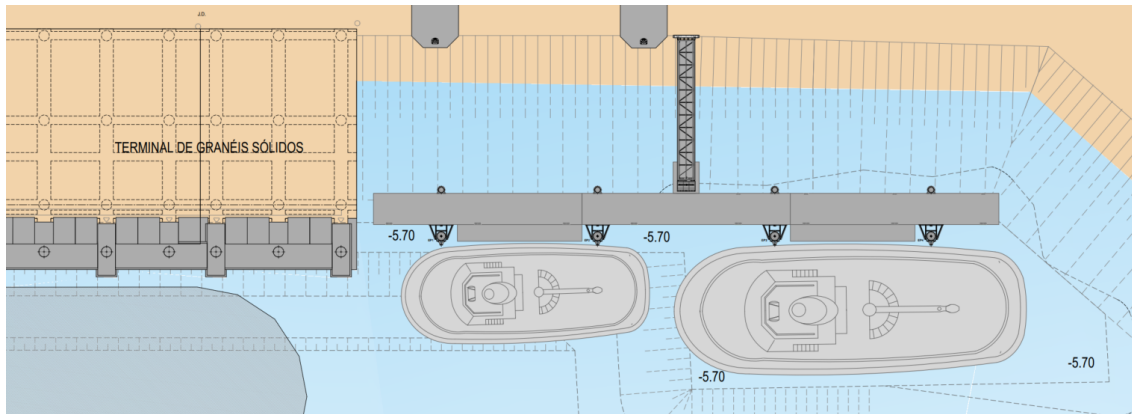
Planta geral do pontão de estacionamento de rebocadores.
